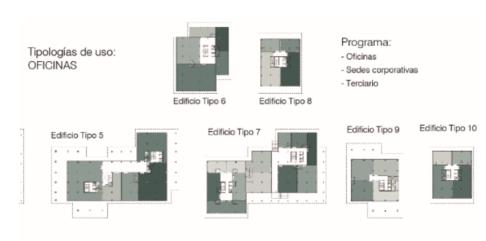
Propuesta de plantas esquemáticas de oficinas
